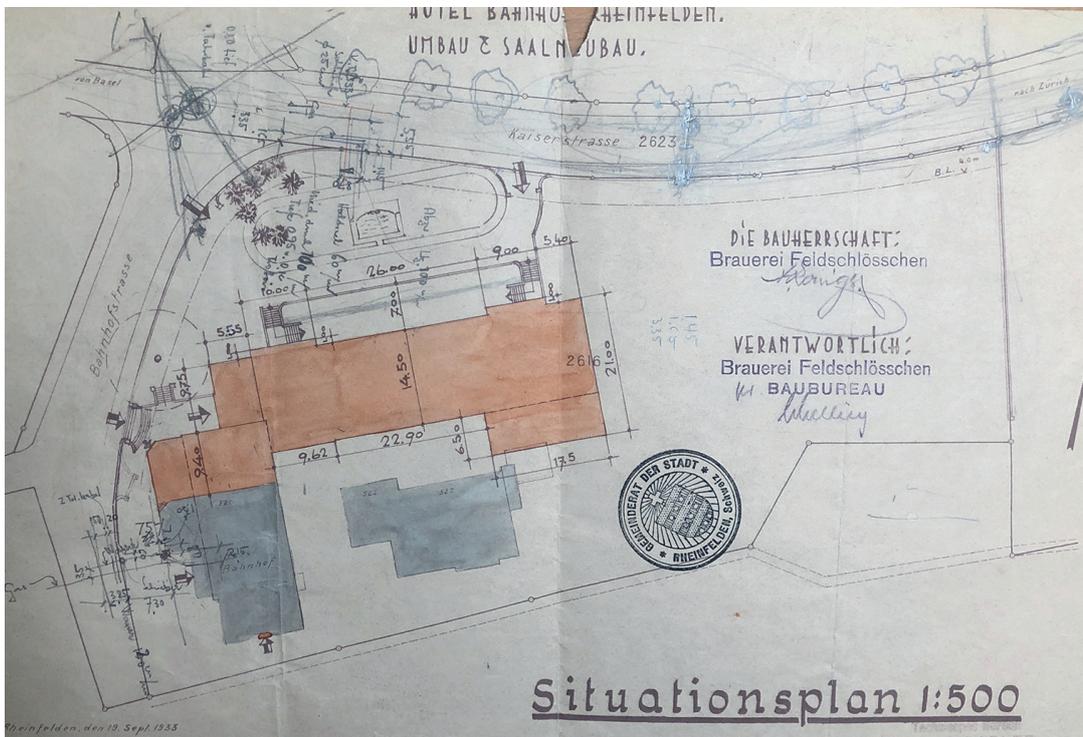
Situationsplan für die Erweiterung des Hotels und den Saalbau aus der Baueingabe von 1933. Quelle: Archiv Stadtbauamt, Dossier 268.
